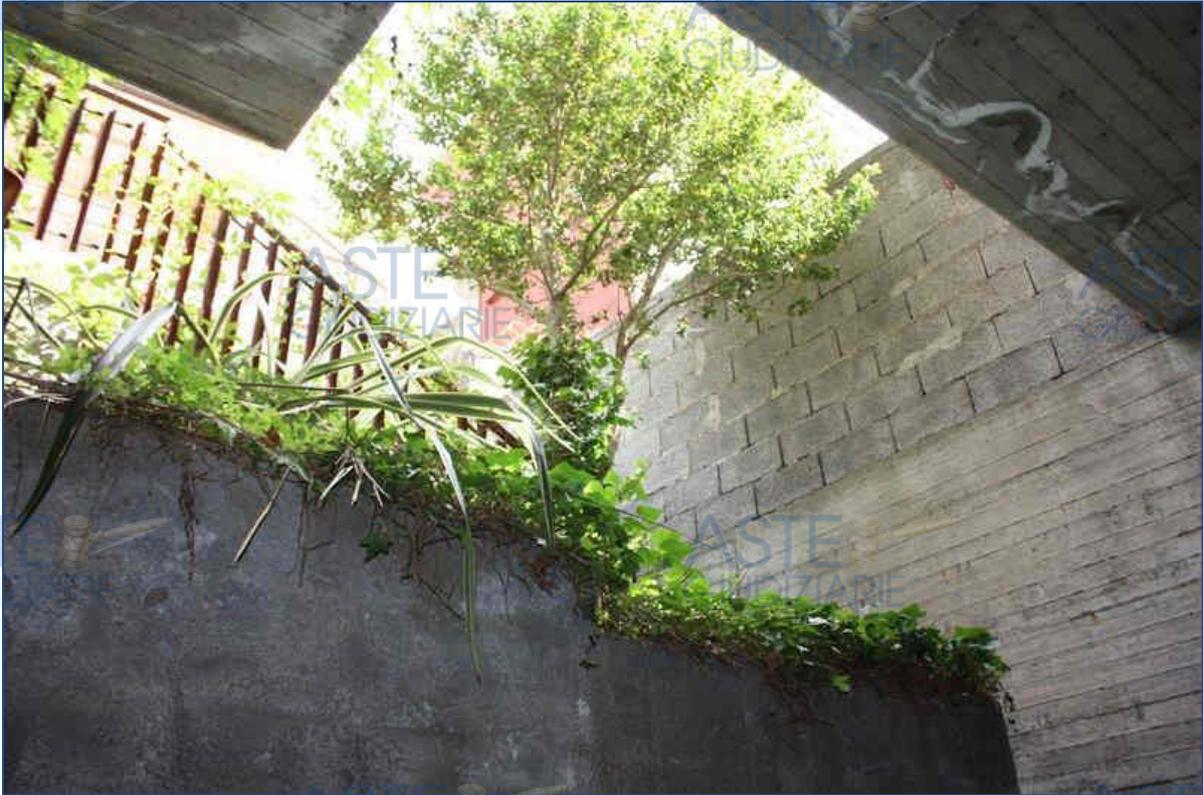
Vista sulla scala di collegamento ai piani superiori
